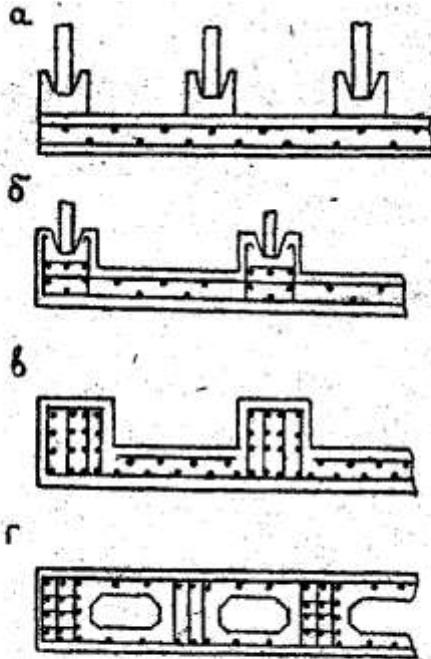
Плитные фундаменты: а - со сборными стаканами;
